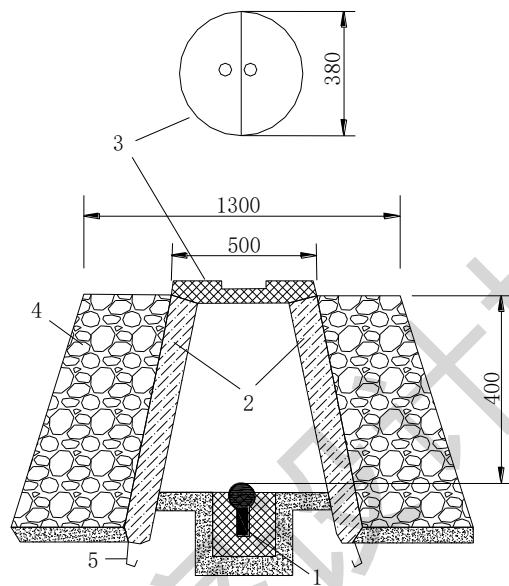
基岩水准基准点标石（单位：mm）
